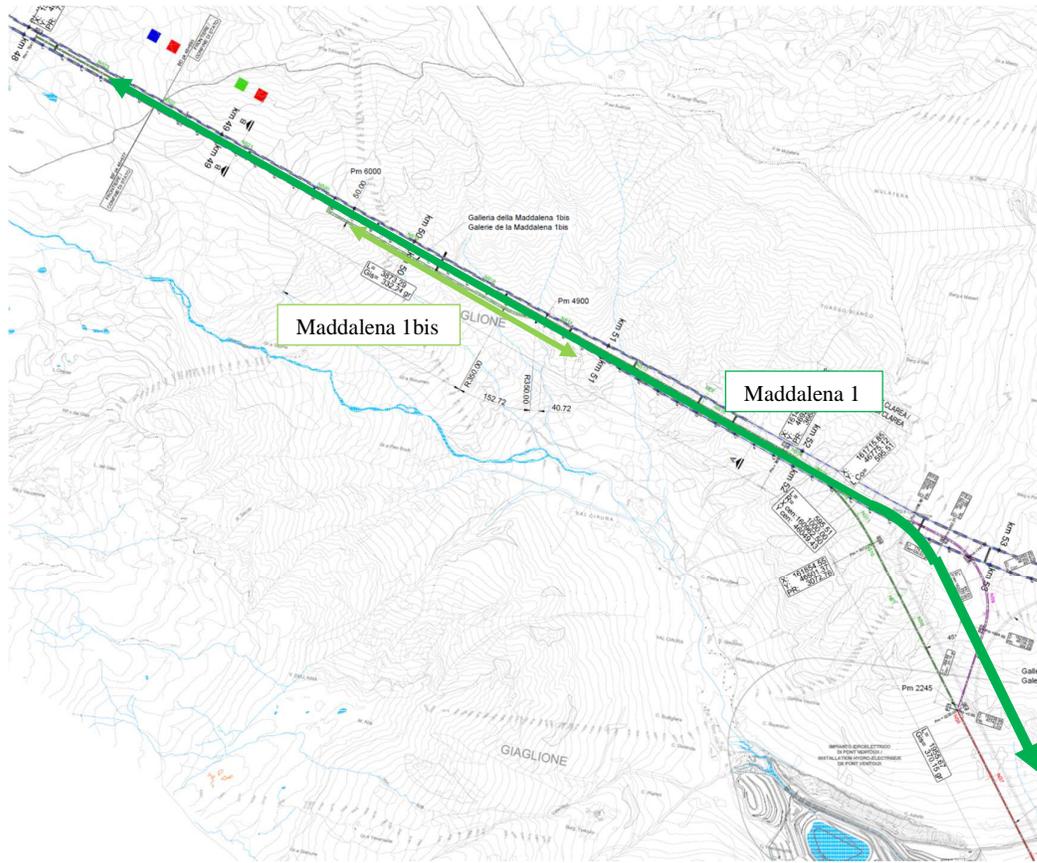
Planimetria zone di stoccaggio in Maddalena 1 e Maddalena 1bis (PRV_C3A_3803_26-48-10)
